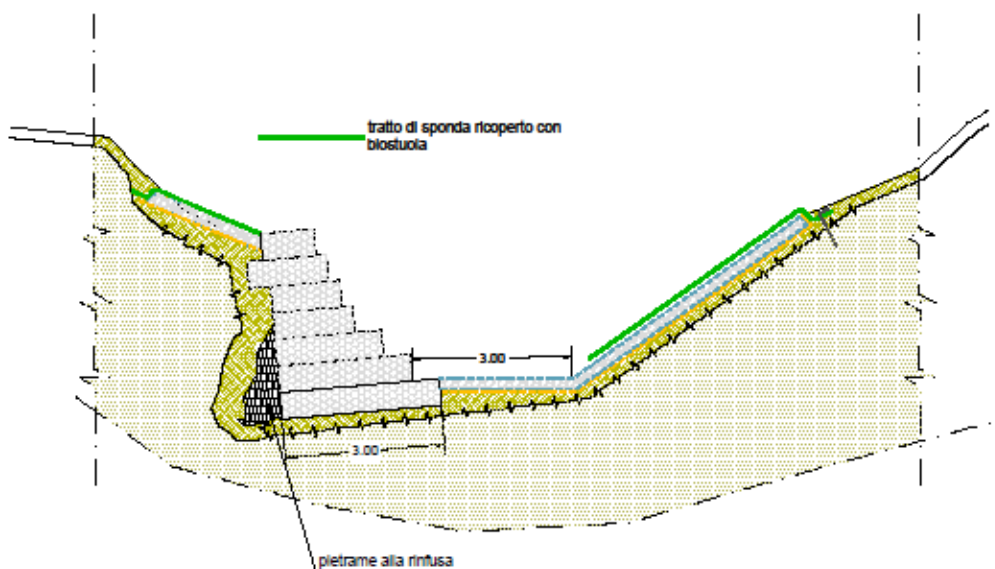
Sezione tipologica - Intervento di stabilizzazione spondale con gabbionate di pietrame
